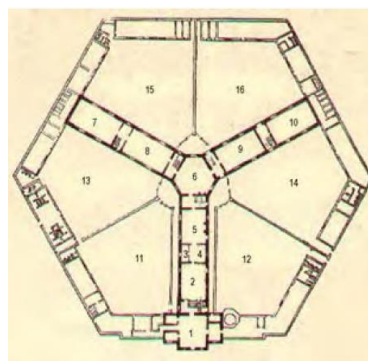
Planta do plano Hexagonal de um dos três modelos de *workhouse
